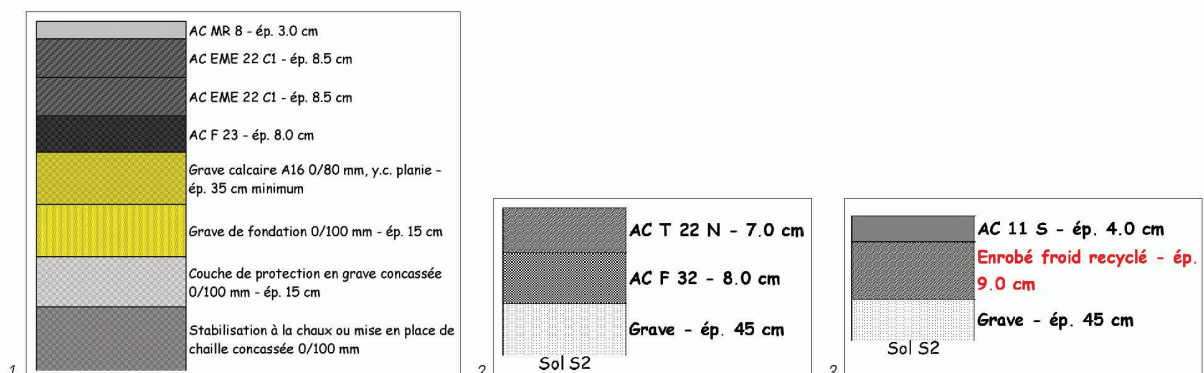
Superstructure de la chaussée pour la plateforme douanière
